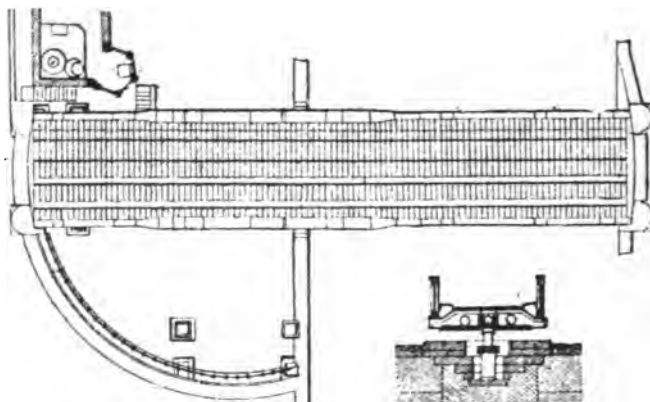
Marsoillo, pont de la Joliette. Plan et coupe transversale.
